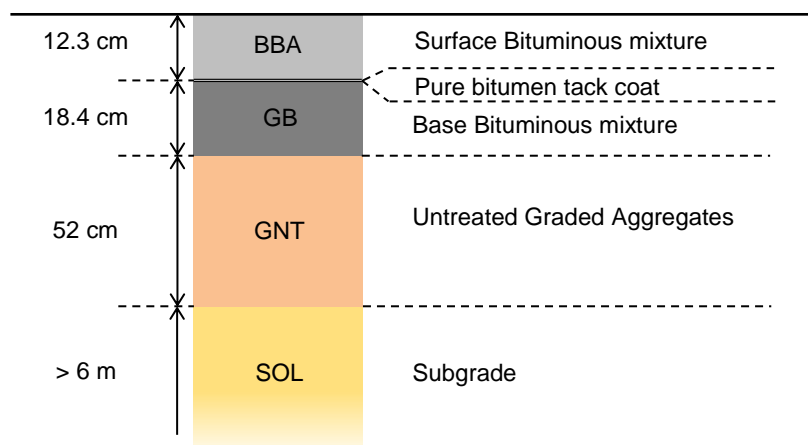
Structure de chaussée simplifiée au niveau de la zone d'essai HWD
